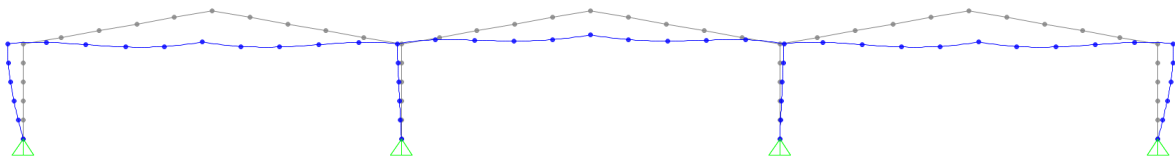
Configuração deformada devido ao carregamento vertical – W (Pórtico PR3)
